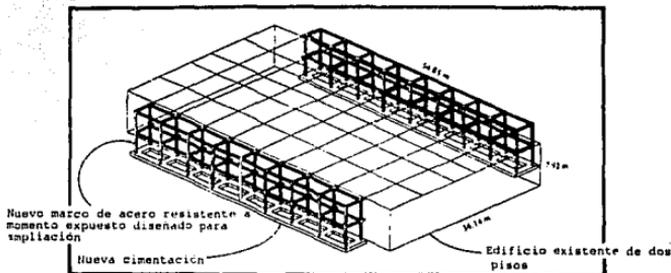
Vista esquemática de refuerzo sísmico, edificio 1.
